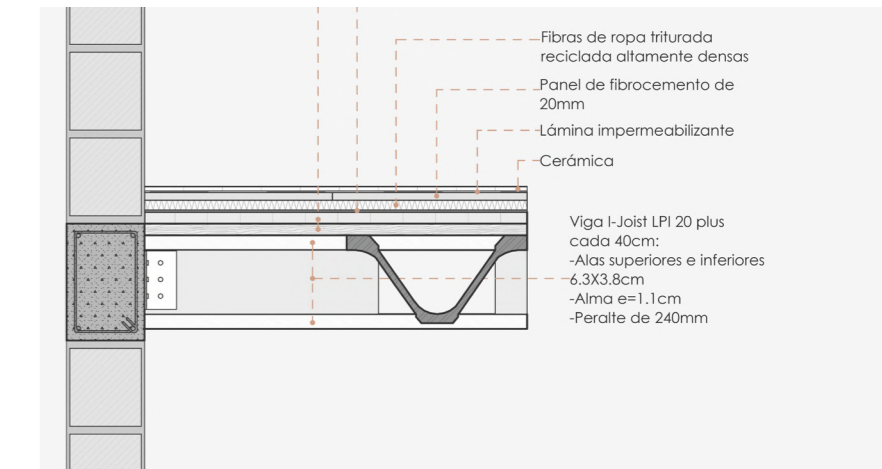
Viga con perfiles de acero galvanizado tipo easi-joist
